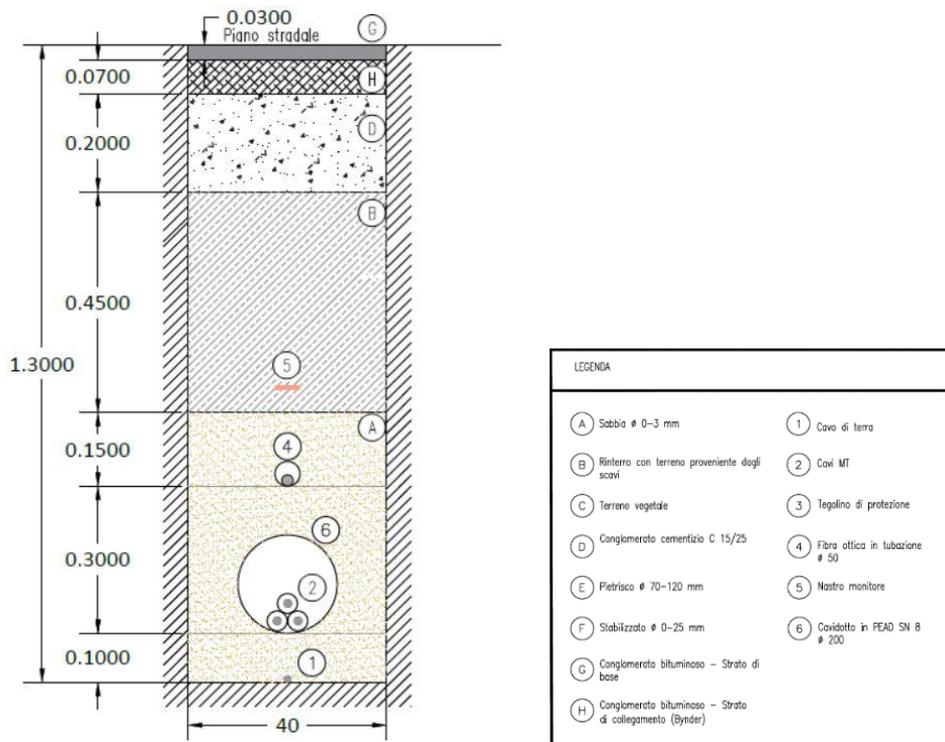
Sezione tipo del cavidotto di progetto su viabilità
